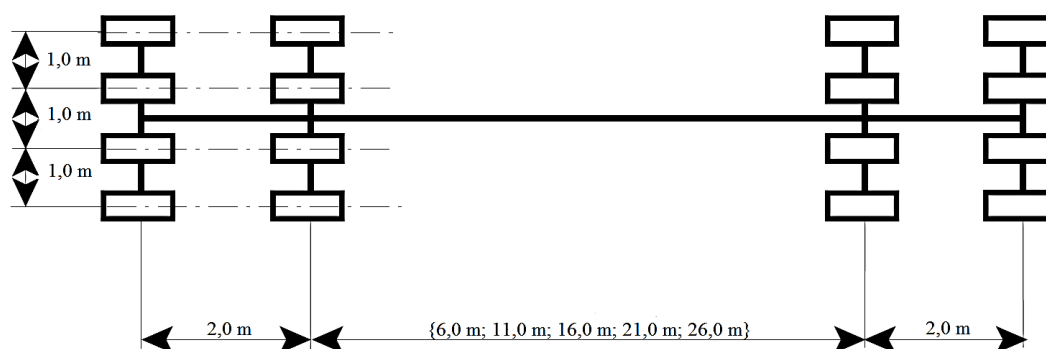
Configuração em planta do modelo NB da SATCC.
